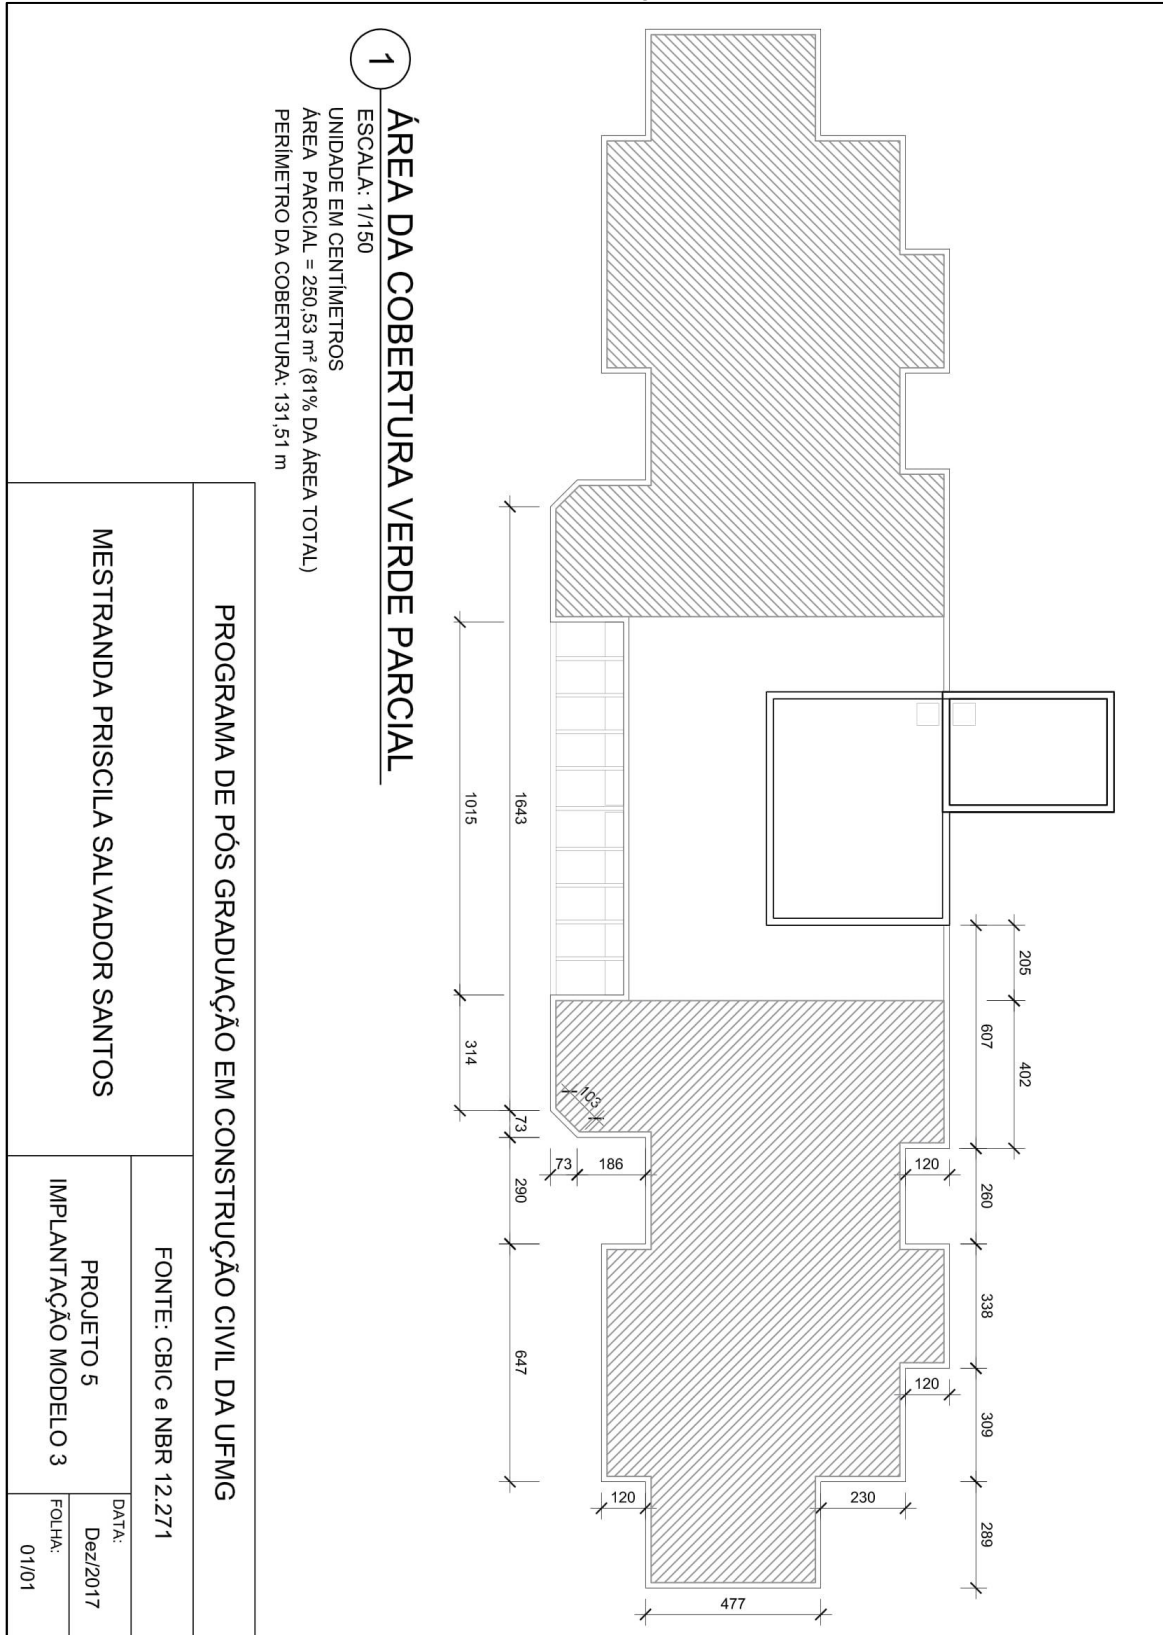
Planta de Implantação Modelo 3 – Projeto 4
